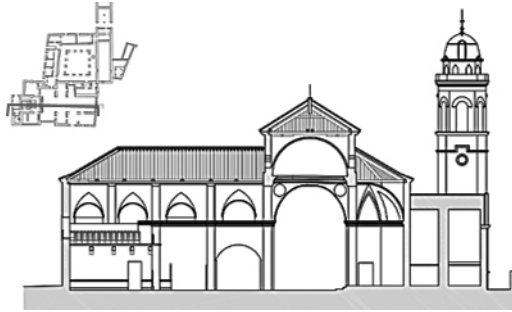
Corte longitudinal del templo referenciado en planta.
